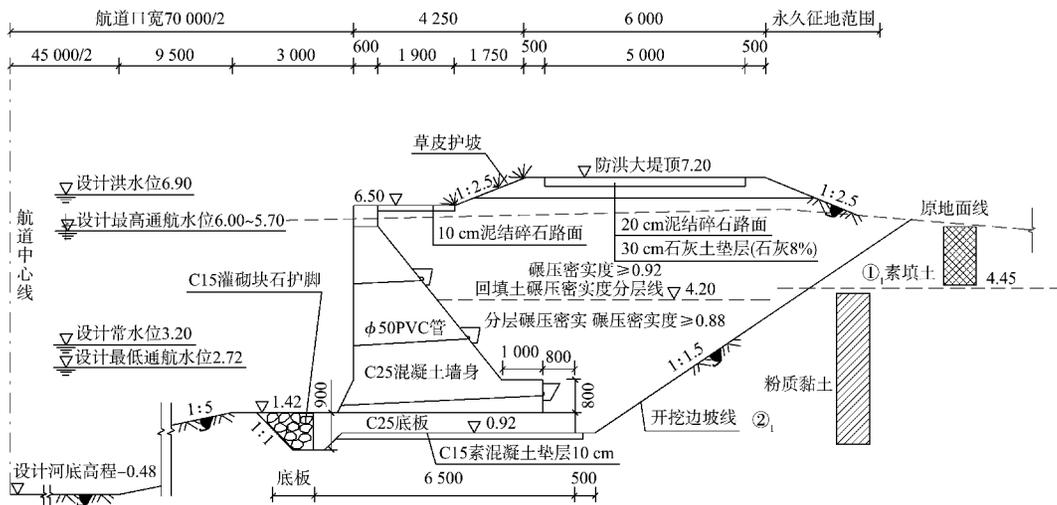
素混凝土重力式结构断面 (高程: m; 尺寸: mm)
